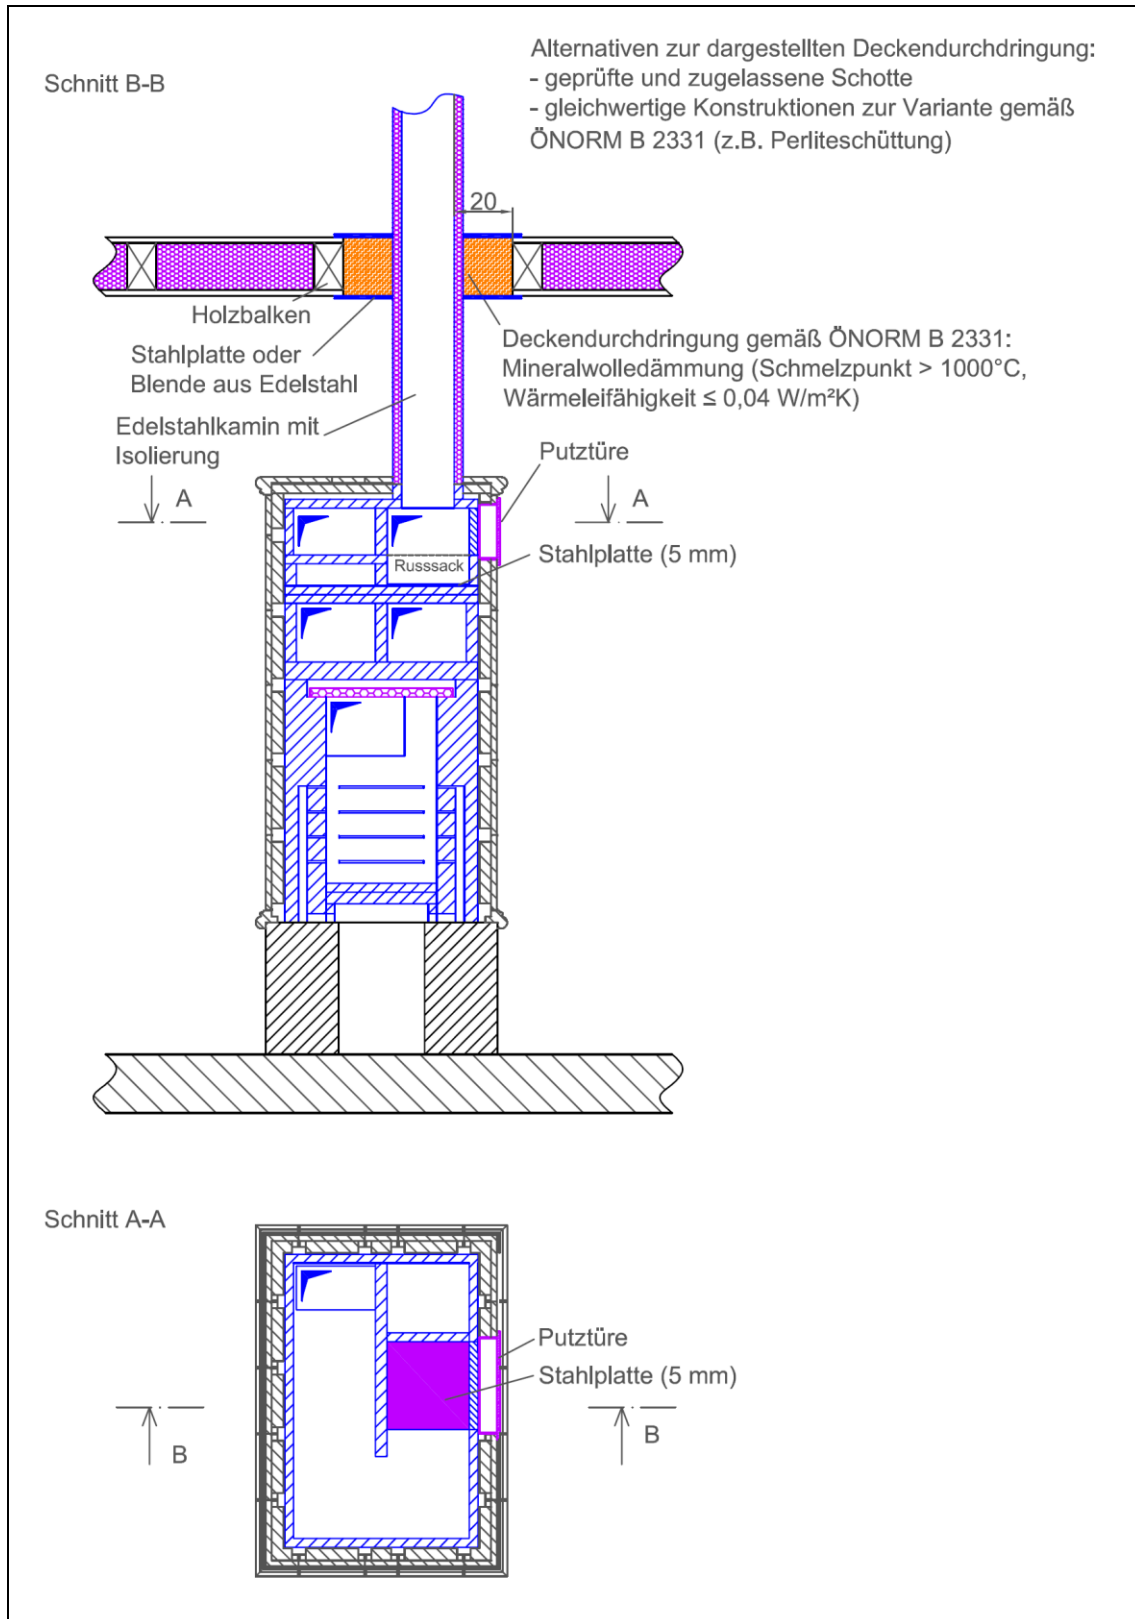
Schwebende Abgasanlage bei einem Kachelofen mit durchgehendem Edelstahlkamin und brennbarer Deckenkonstruktion
